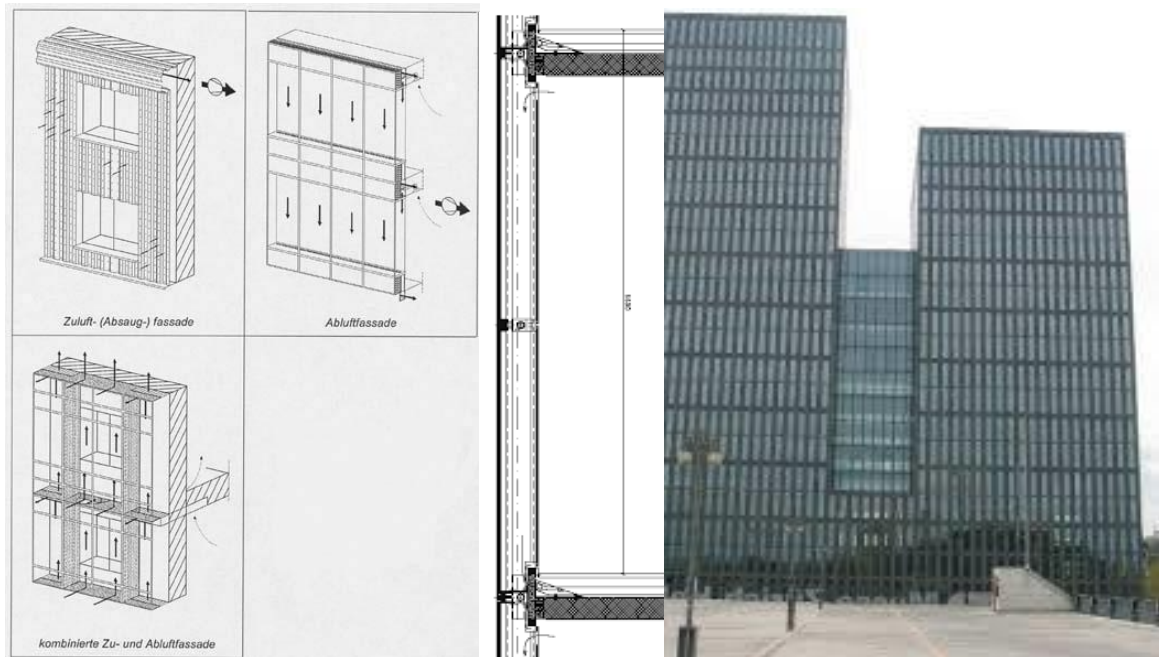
In den axonometrischen Darstellungen (links) werden verschiedene Möglichkeiten der Luftführung in der Fassadenschicht schematisch aufgezeigt. Beispiel einer Abluftfassade (rechts) anhand eines Fotos und des dazu gehörigen Fasadenschnitts (Sunrise Tower, Zürich Nord. Architektur: Planergemeinschaft Atelier WW / Max Dudler. Energie + Haustechnik: Gruenberg & Partner AG / Schneider Engineering + Partner AG. Fassadenplaner: Stäger & Nägeli AG)
